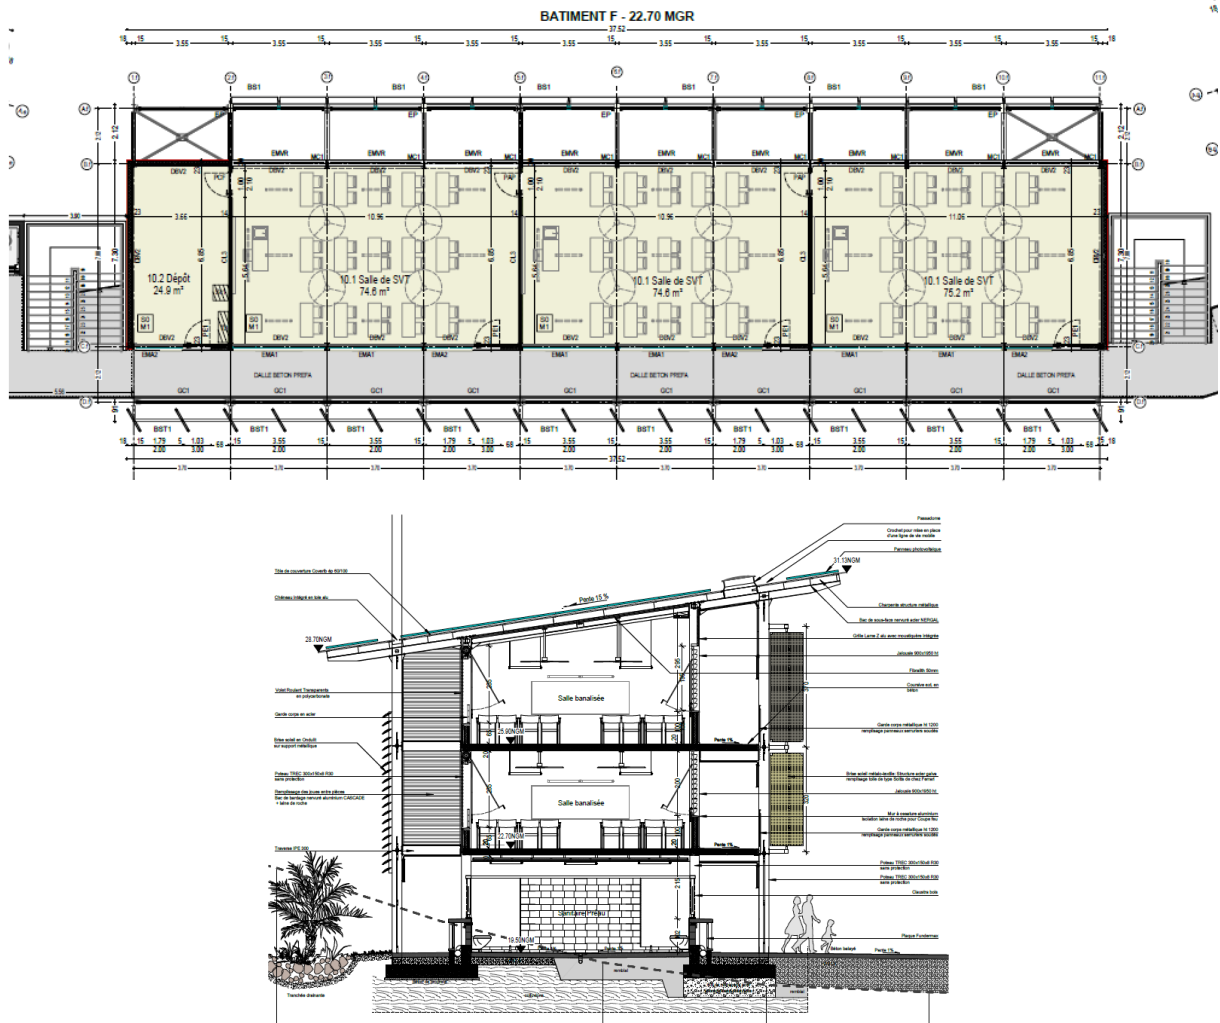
30: Illustration des protections solaires des façades d'un bâtiment d'enseignement type, plan (en haut) et coupe(en bas) © Antoine Perrau Architectures
